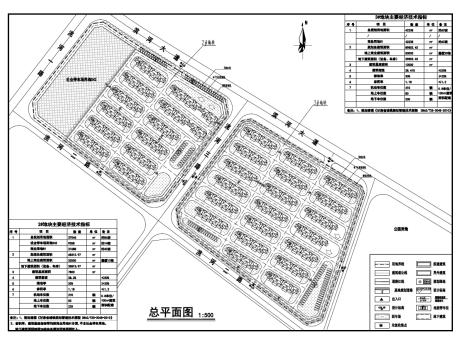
DX02-01-03、DX02-02-02 地块意向方案总平面图
